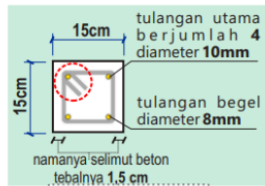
Kerusakan akibat Kesalahan Detailing Sloof
